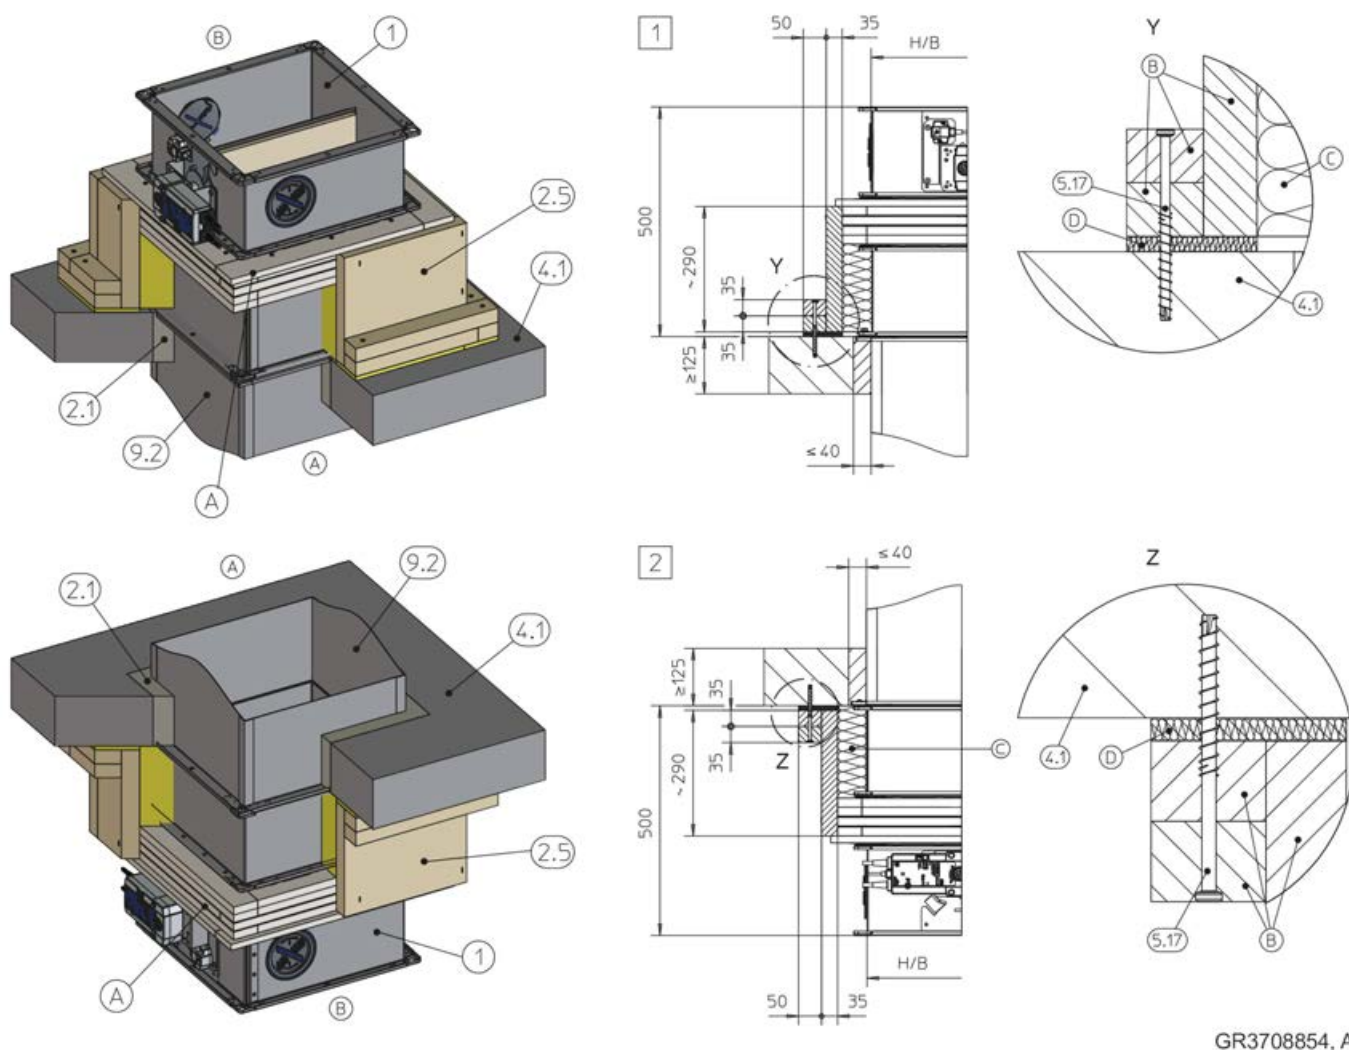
Installazione a secco sopra un soffitto a soletta piena con kit d'installazione WA
